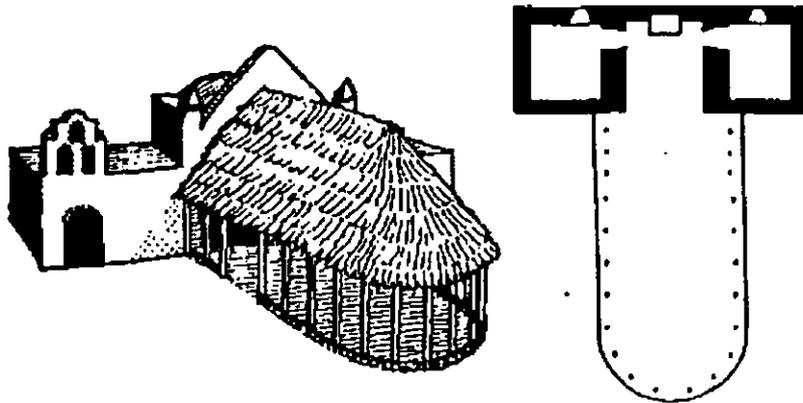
Típica ramada del siglo XVI (vista y planta) (fuente: “*Mayan Missions...*”)
